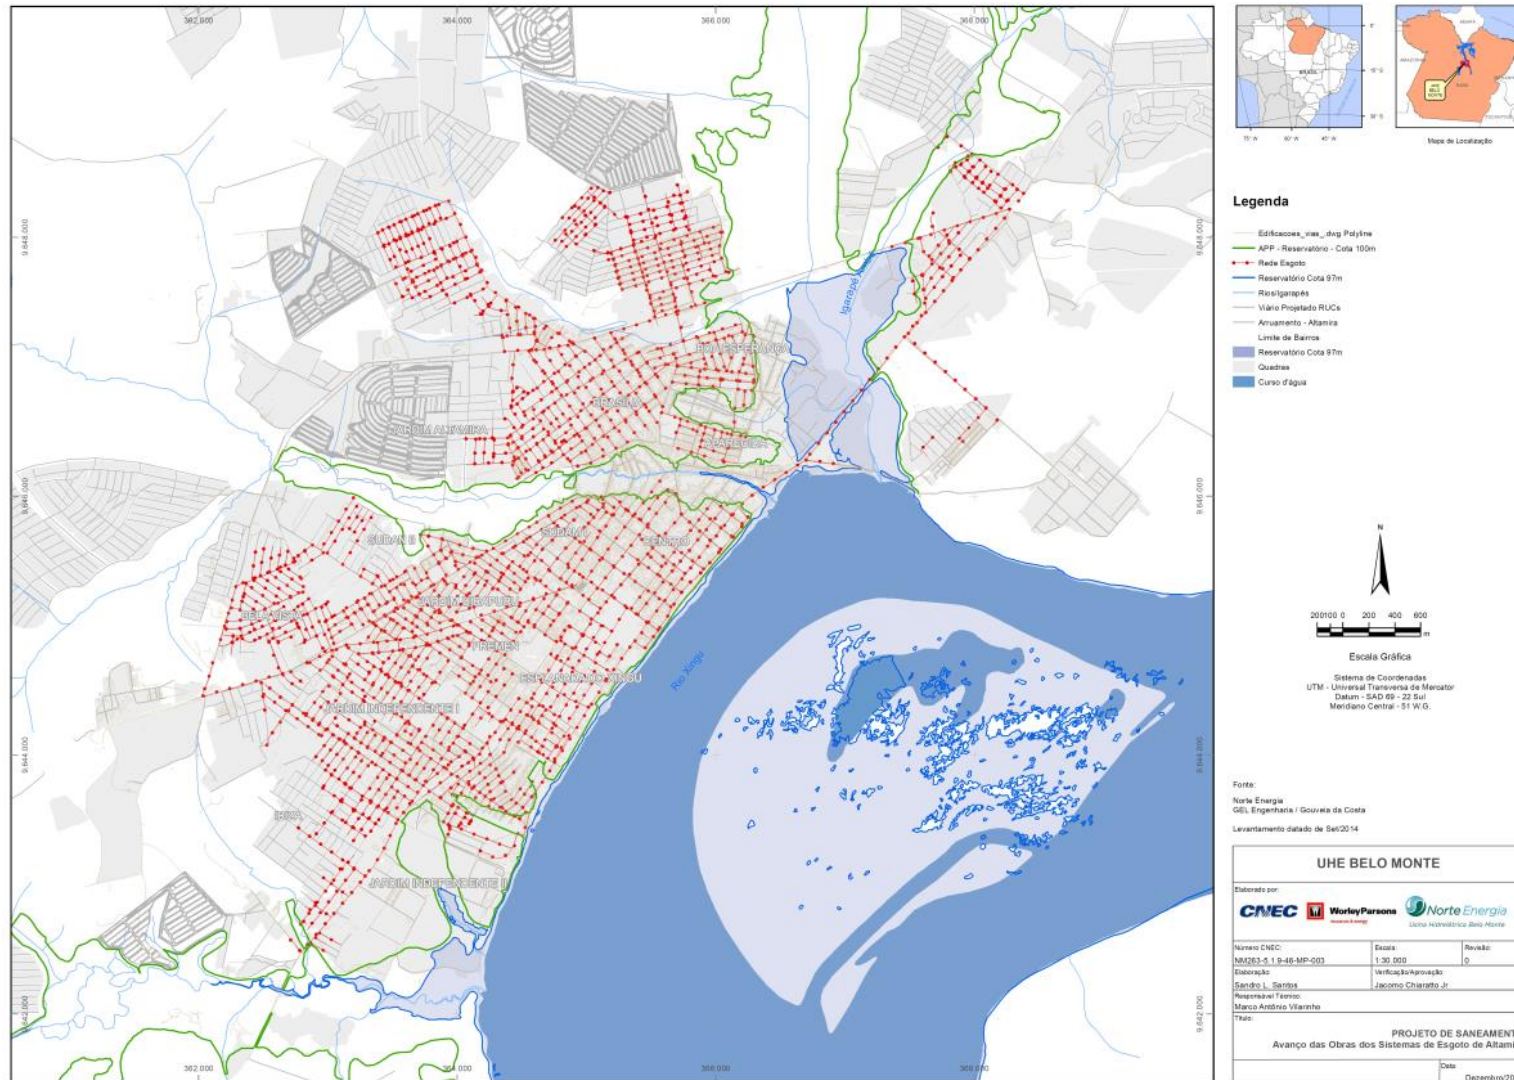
Abrangência das Obras de Esgotamento Sanitário.
